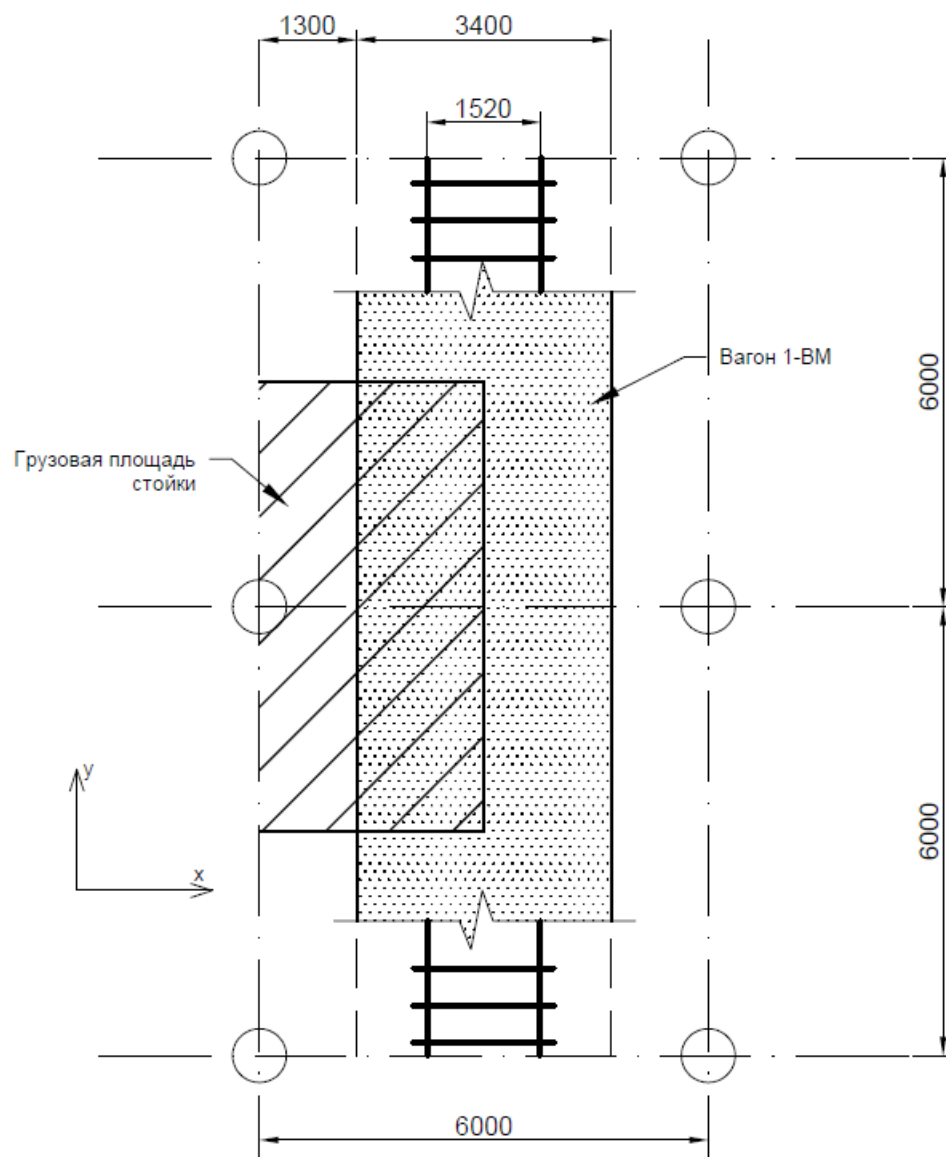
Случай 1 нагружения трубобетонной стойки
